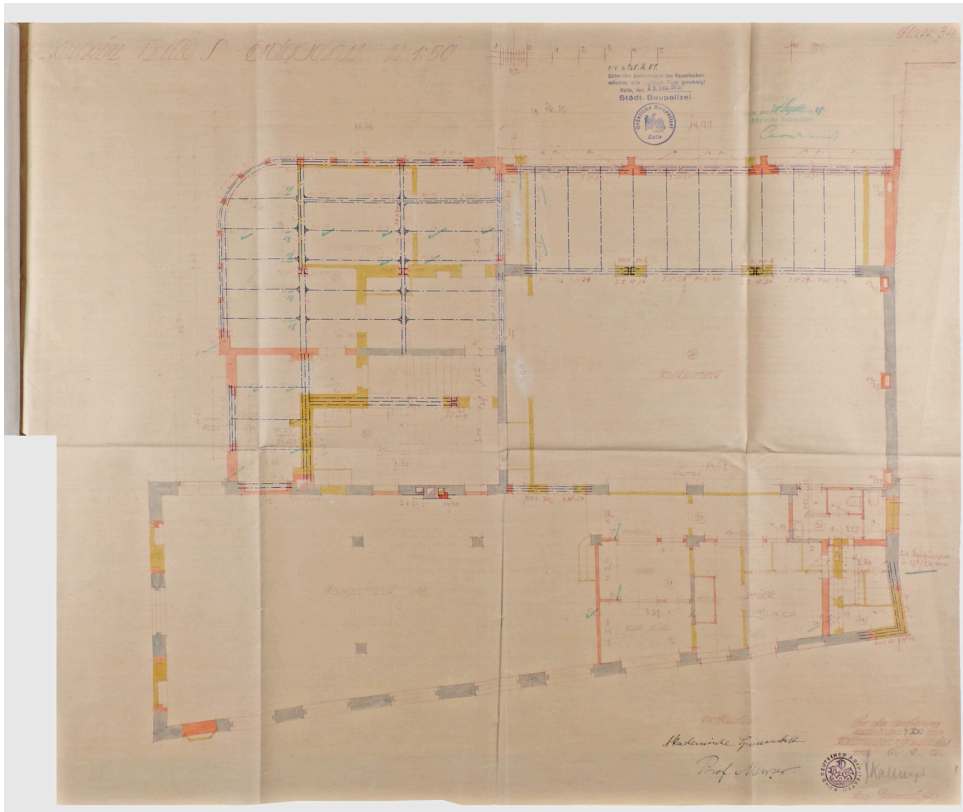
Um- und Erweiterungsbau der akademischen Speiseanstalt im Universitätsring 5 in Halle, Grundriss Erdgeschoss, datiert 7. Juli 1928.
